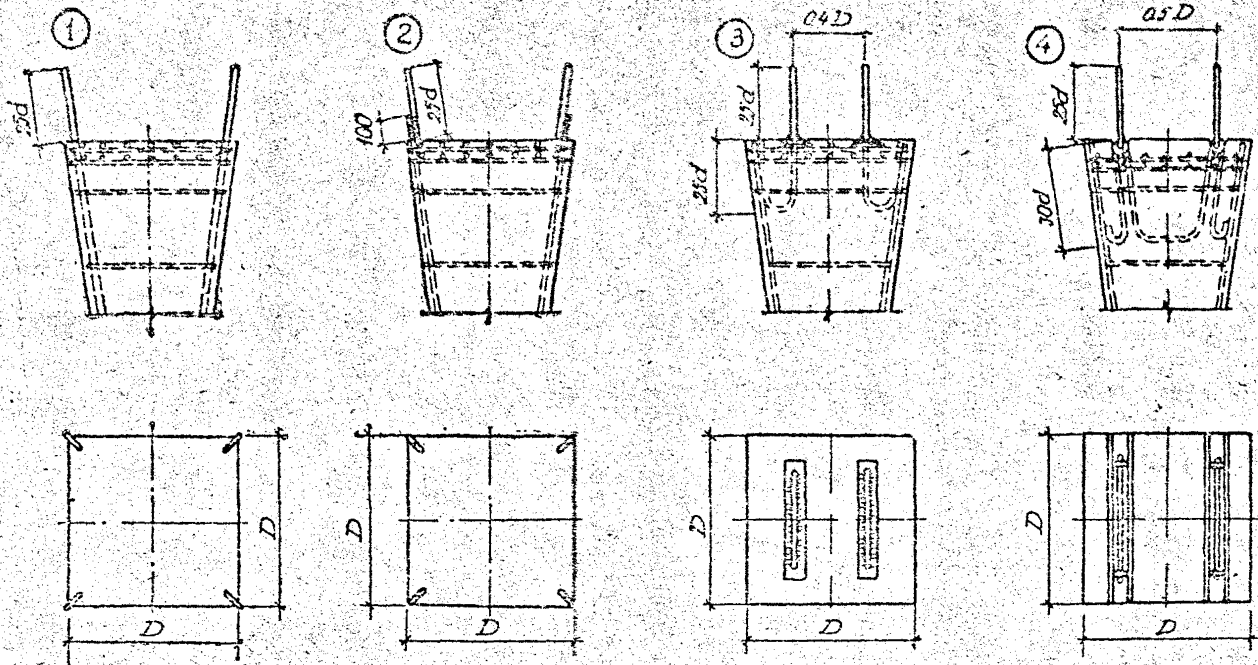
Конструкции верхней части пирамидальных свай при восприятии горизонтальной нагрузки.
